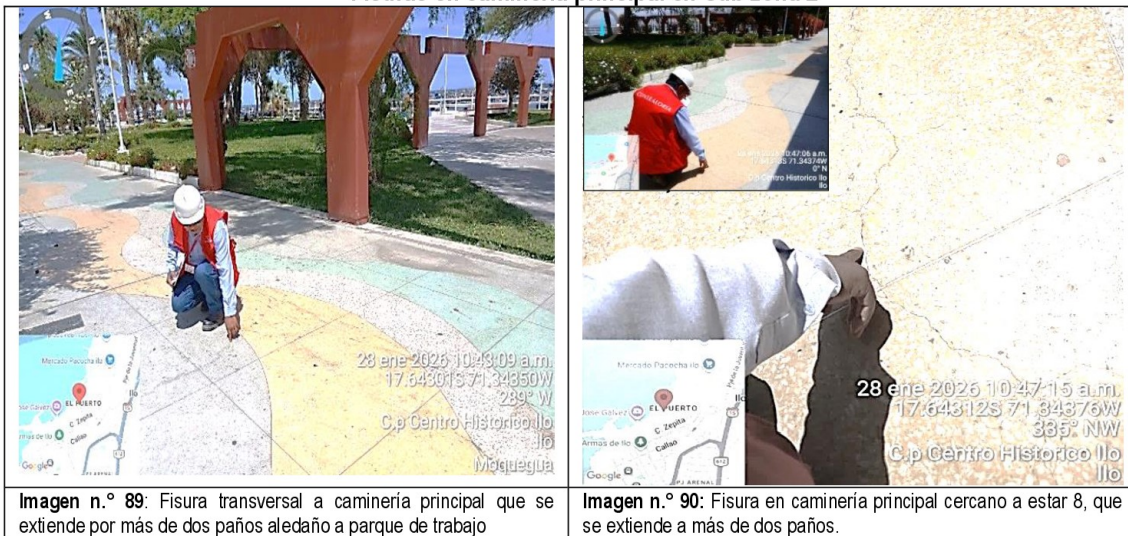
Fisura transversal a caminería principal que se extiende por más de dos paños aledaño a parque de trabajo
